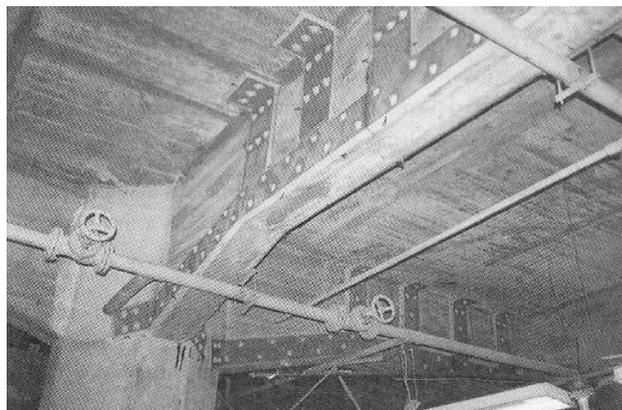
Exemplo de reforço com chapas metálicas chumbadas.
